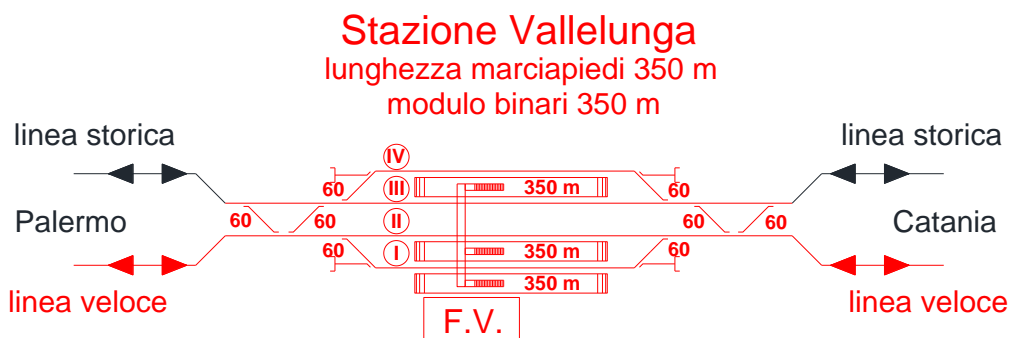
Layout funzionale di progetto – Stazione di Vallelunga
